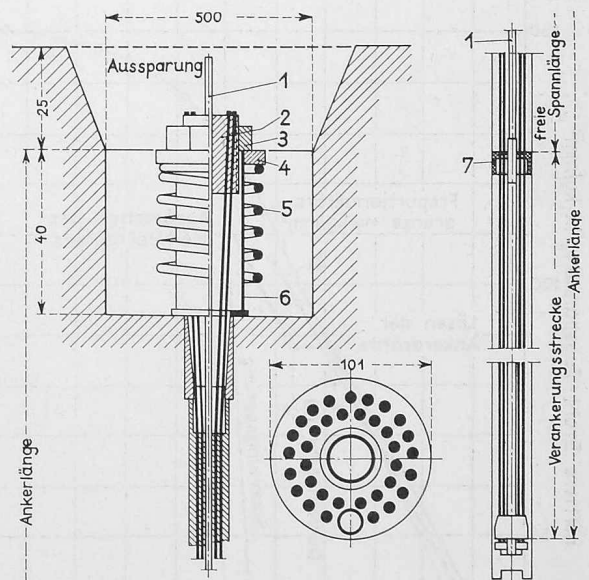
Längs- und Querschnitt der 138-t-Anker in der Südmauer, bestehend aus 35 Spannstahldrähten $\varnothing 7$ mm
